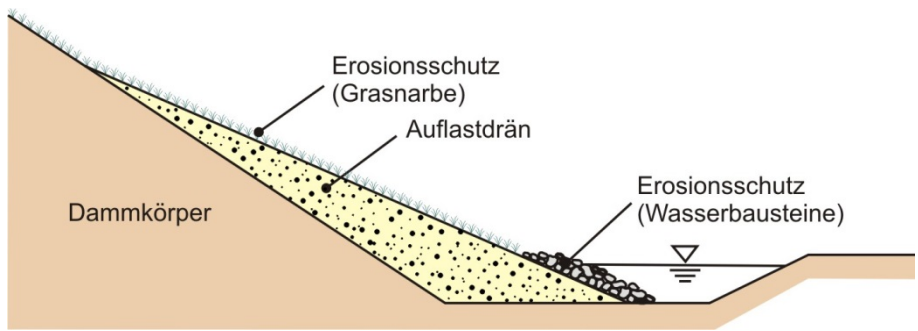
Auflastdrän mit Einstau durch ein Gewässer
